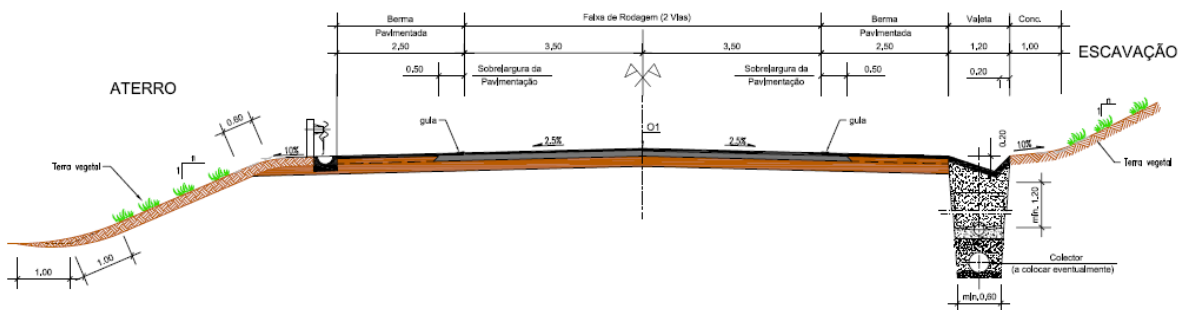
Perfil Transversal Tipo dos Restabelecimentos
